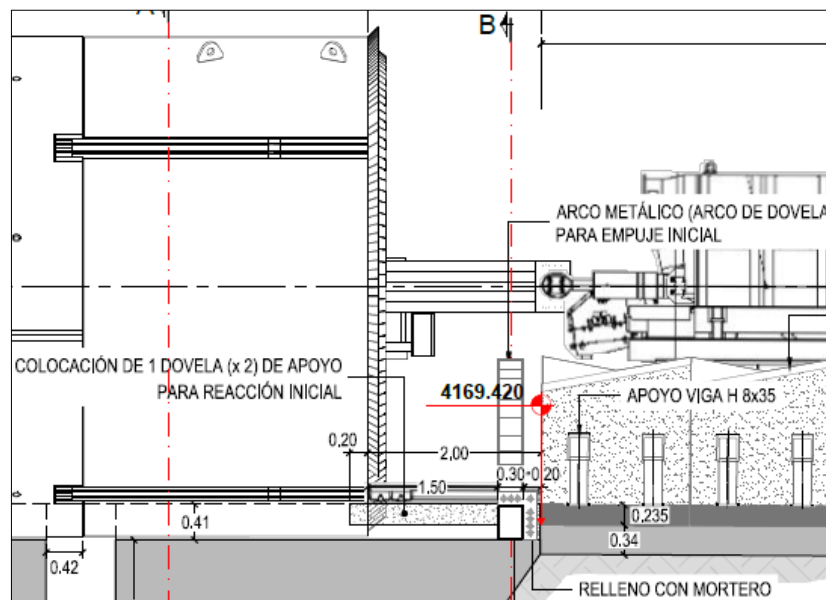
Detalle perfil arco metálico para empuje inicial
